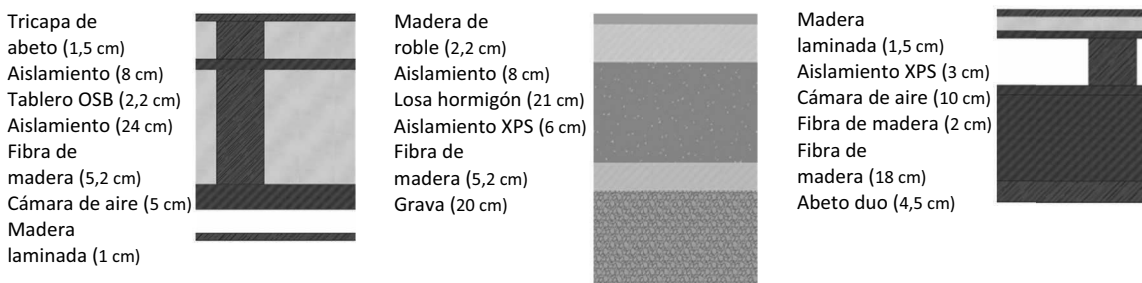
Sección muro tipo, planta sótano y cubierta, respectivamente
